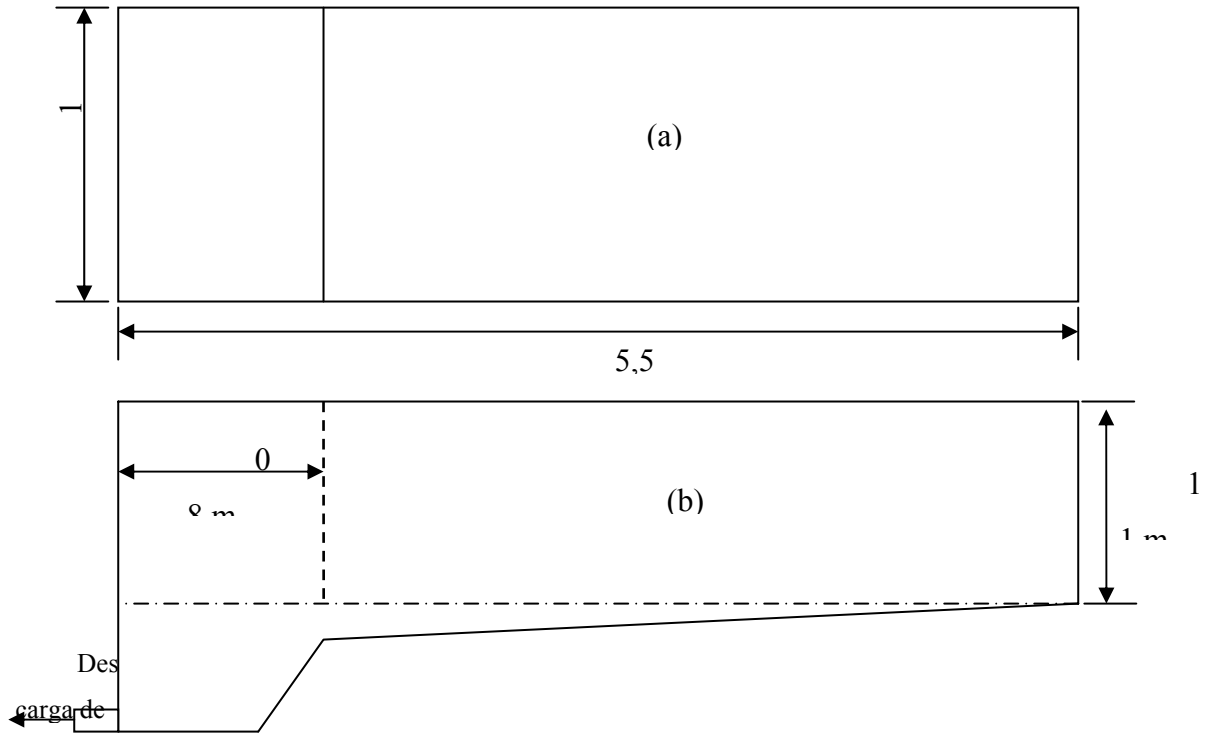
Dimensiones del sedimentador seleccionado: (a) vista de planta, (b) corte lateral.
